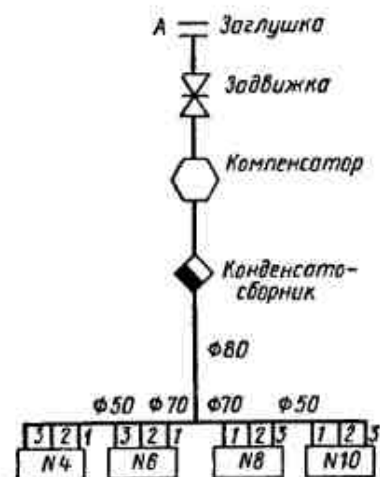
Схема распределительных дворовых газопроводов низкого давления
